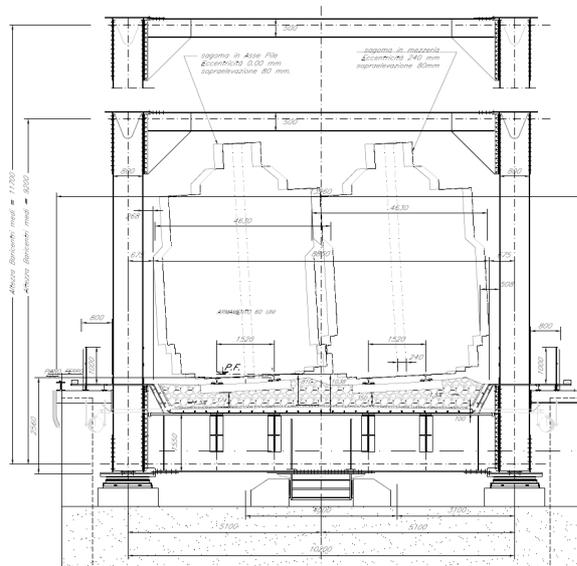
Sezione tipo – Campate a struttura reticolare in acciaio a via inferiore a doppio binario L=68m
